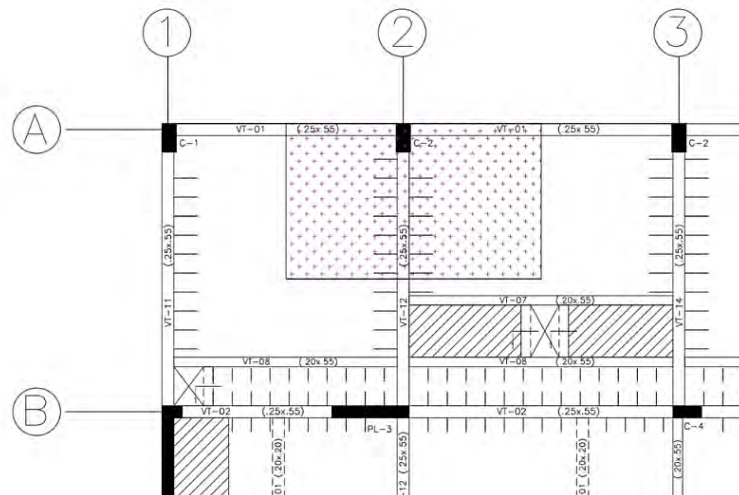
Delimitación de columna entre ejes A-2 de sistema de muros
